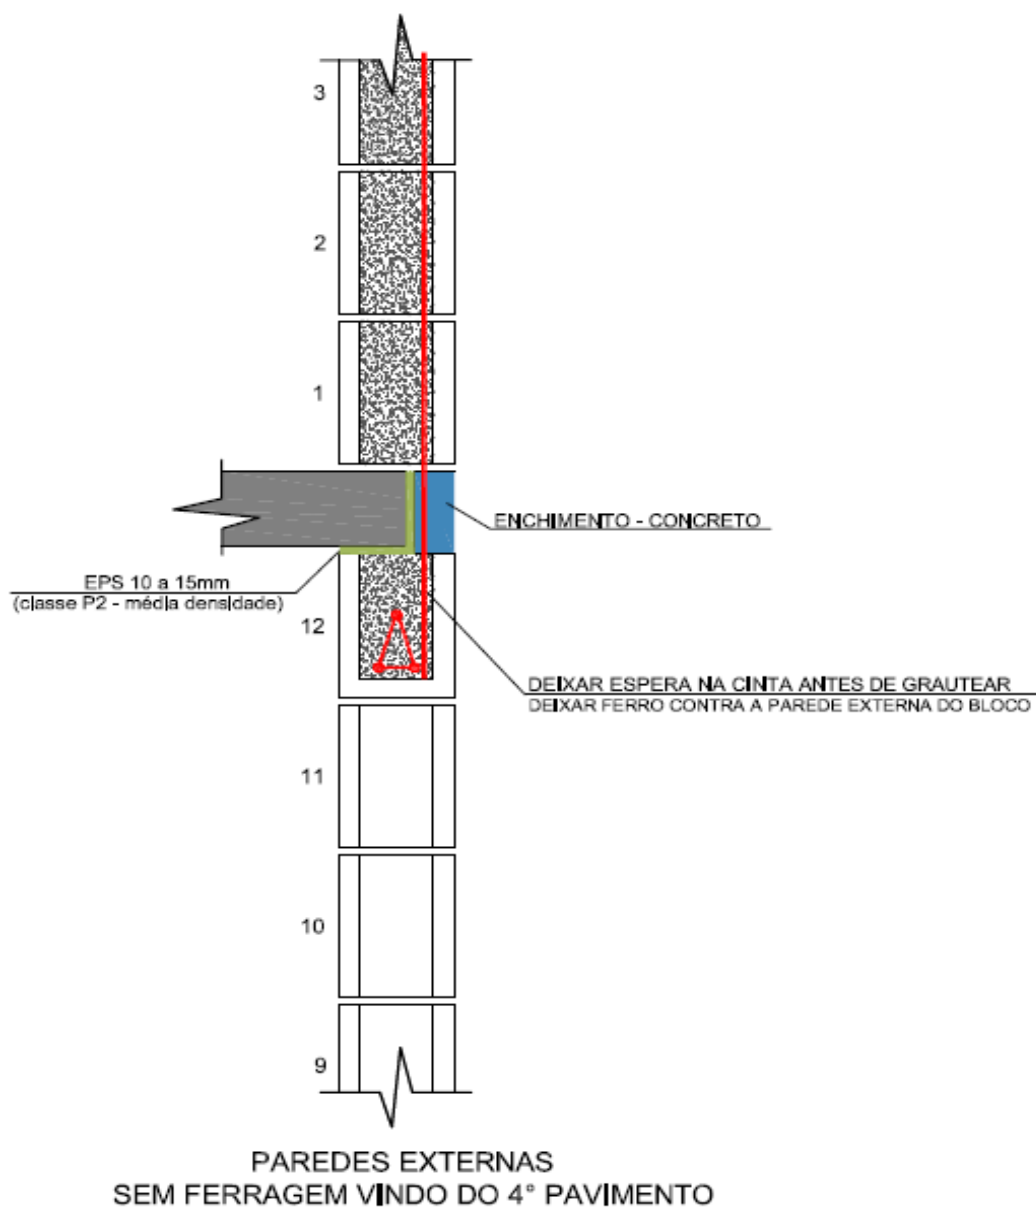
detalhe do apoio das lajes pré-fabricadas em paredes externas sem ferragem vindo do 4º pavimento
